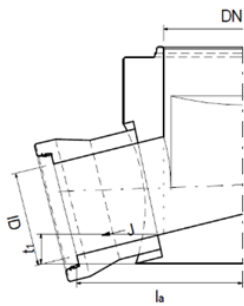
Anschluss mit eingebautem Muffenstück in Schachtwand, Muffenstück bis unter die Sohle
